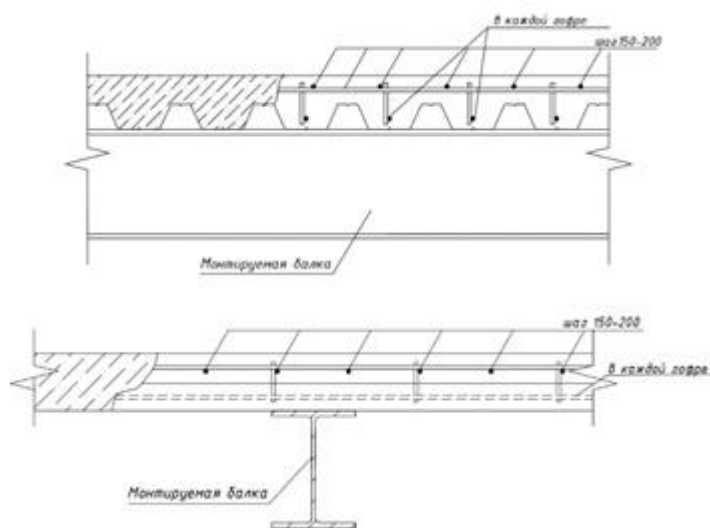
Схема армирования плиты перекрытия по профилированному листу.
